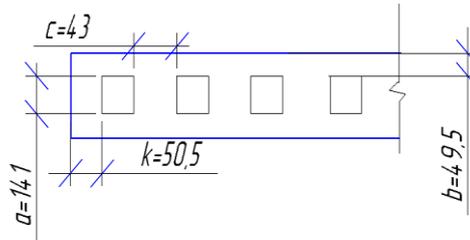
Расчетная схема железобетонной многопустотной плиты
